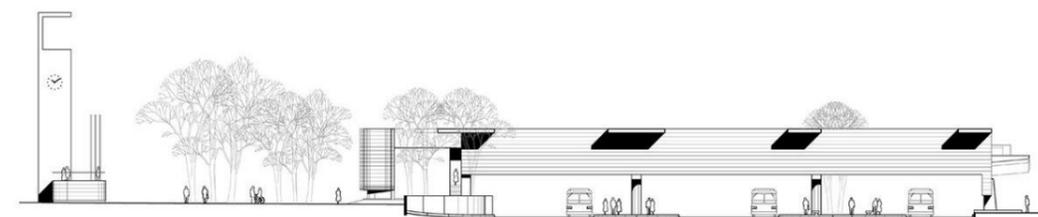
FACHADA. FONTE: ARCHDAILY.
